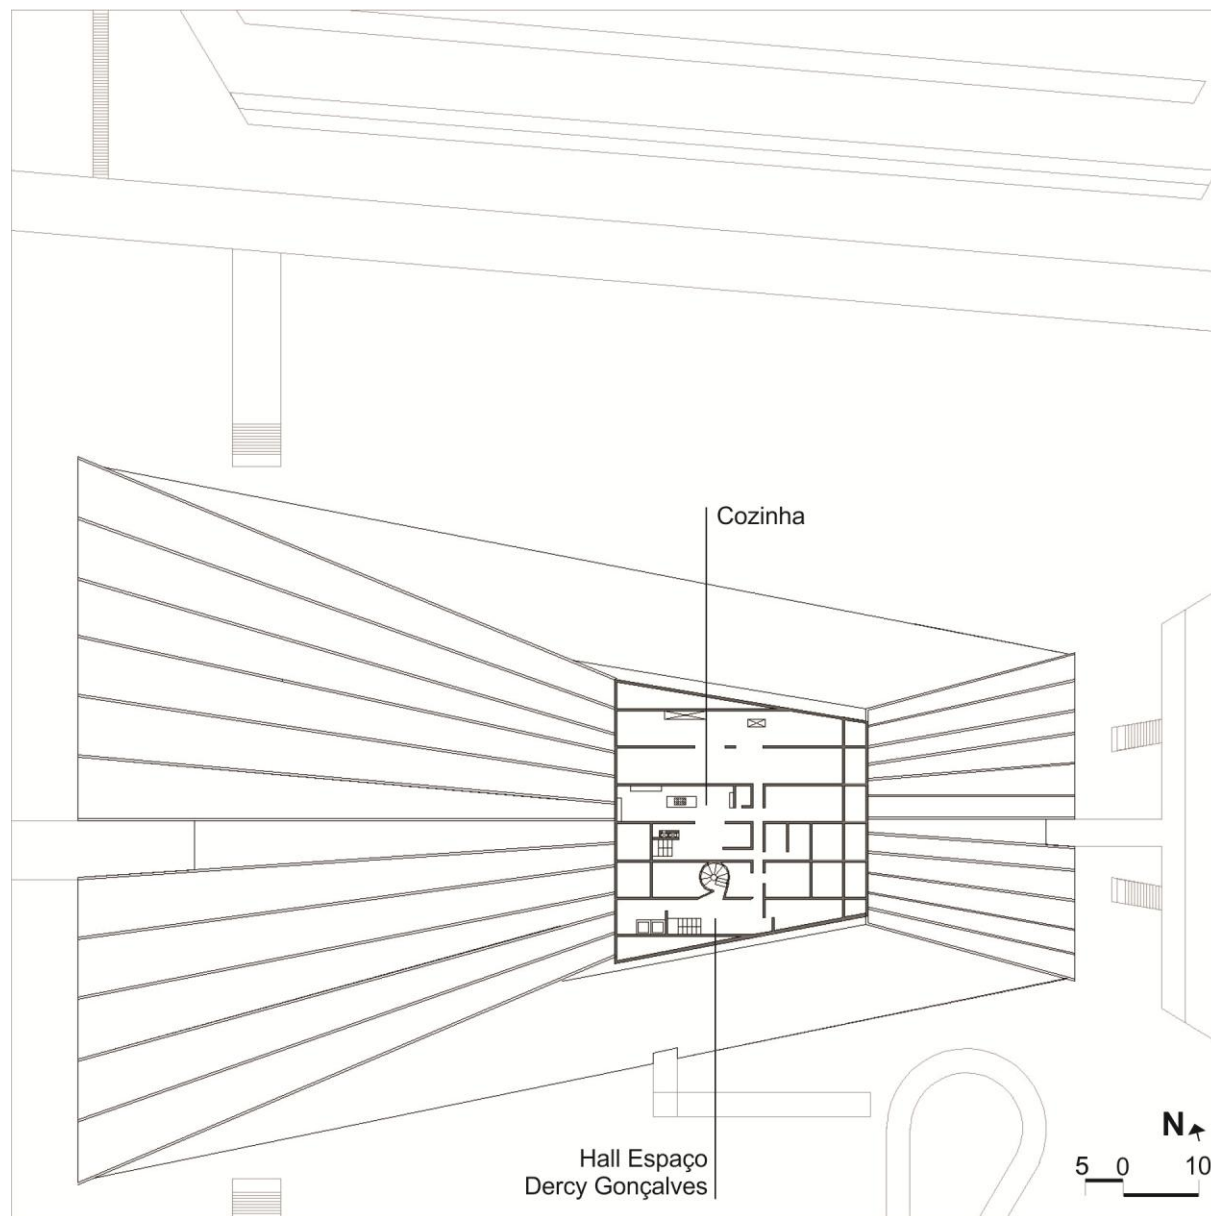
Planta Baixa - 3º Pavimento (+17,65 m).
